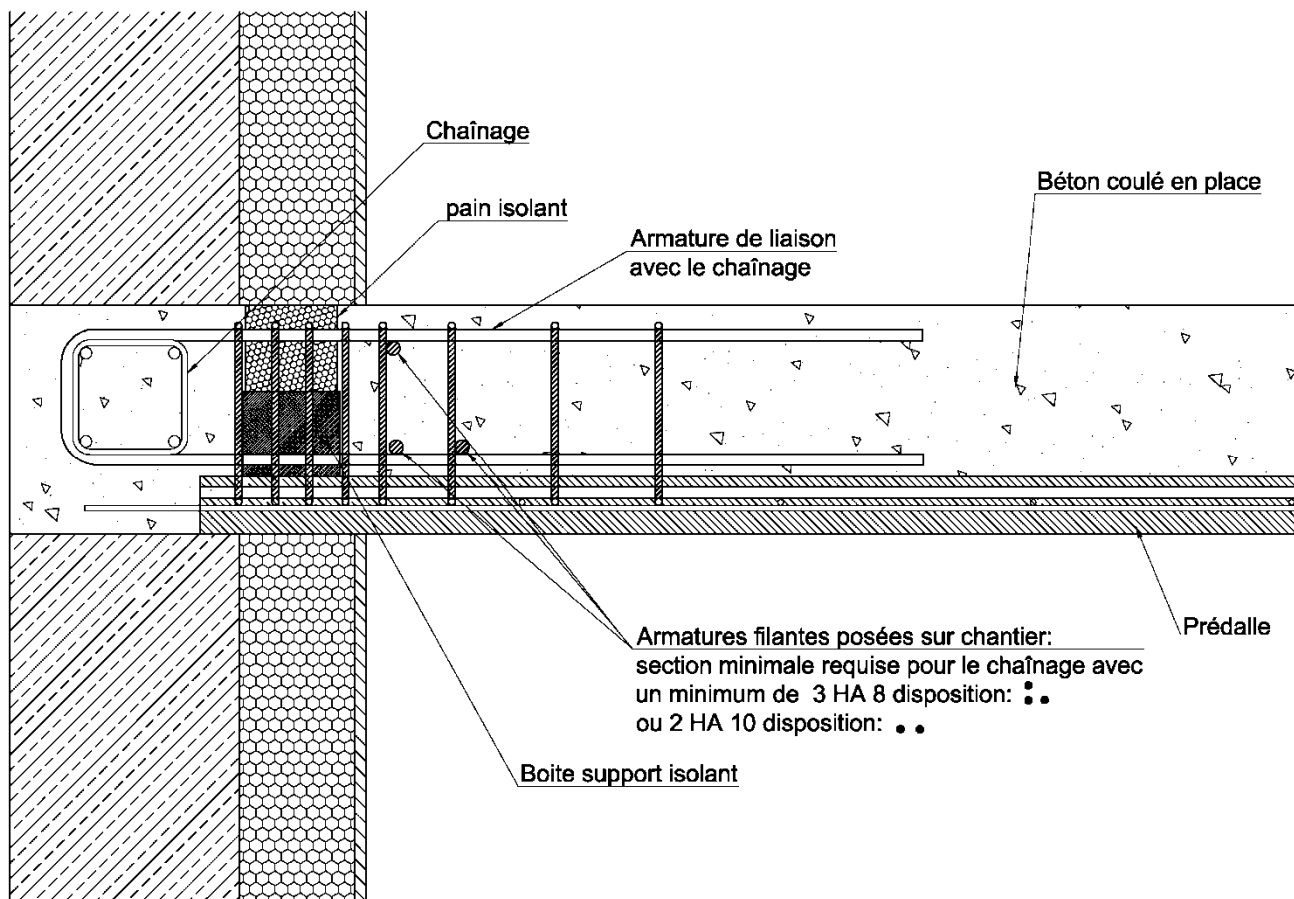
Détail de liaison voile-plancher avec panier de type B
